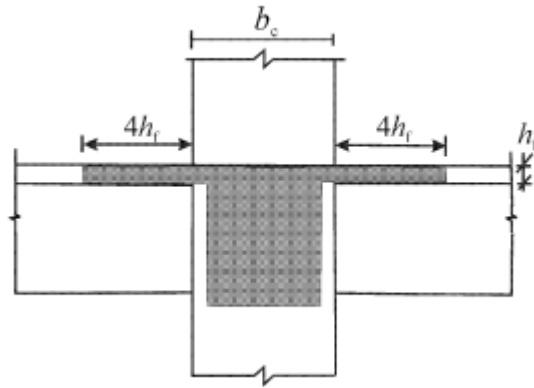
Largura efetiva do banzo de uma viga ligada a um pilar interior, com viga transversal
